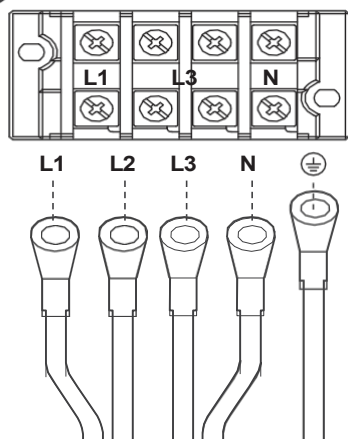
Vereisten voor de bedrading van de stroomvoorziening
